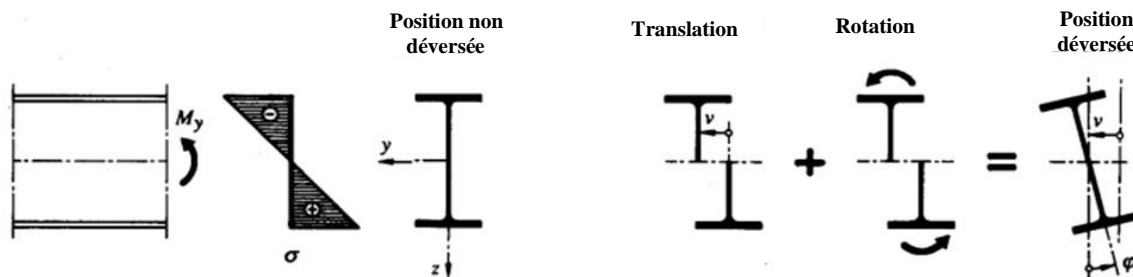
Translation et rotation d'une section d'un élément de poutre sujet au déversement.
